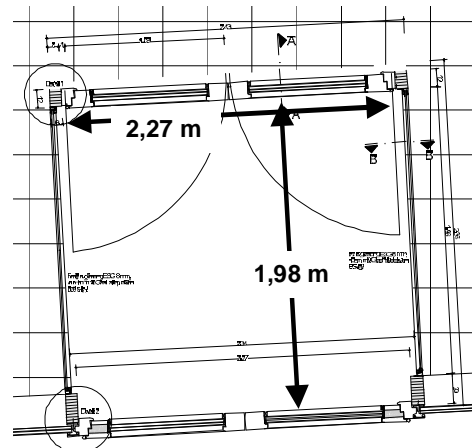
Windfang Pausenhof / Grundriss (nach Architekten 4a, Stuttgart)
